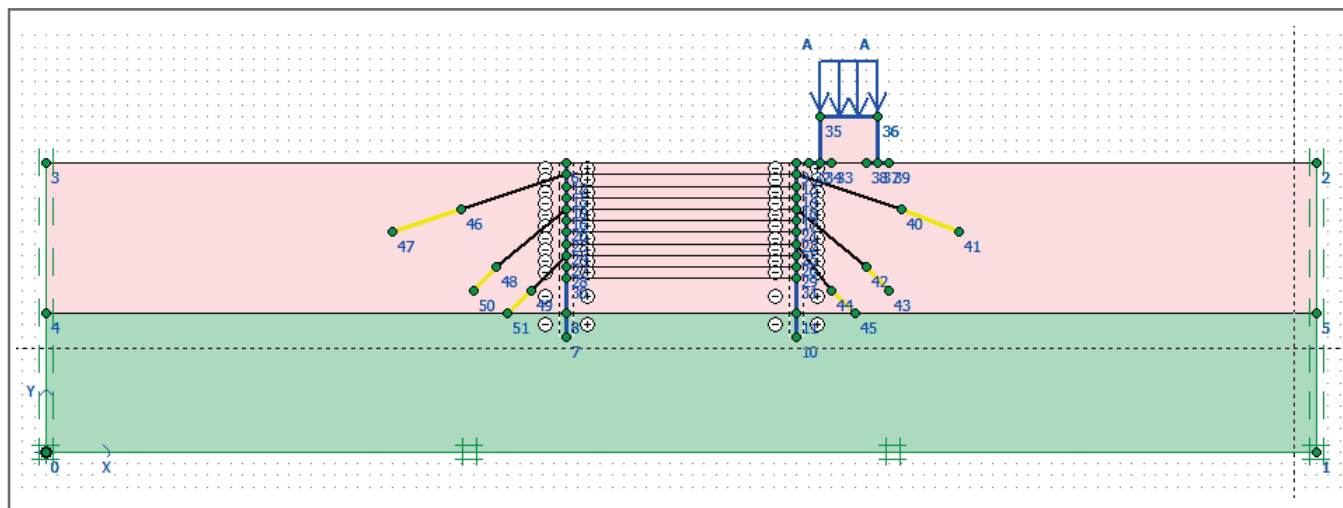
Схематический вертикальный разрез котлована с системой грунтовых анкеров для поддержки подпорных стенок [7]
